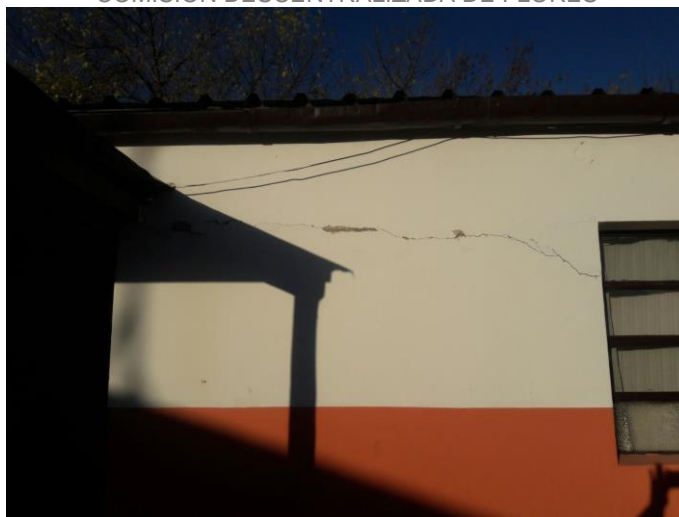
Fisura exterior en pared de galería hacia patio
